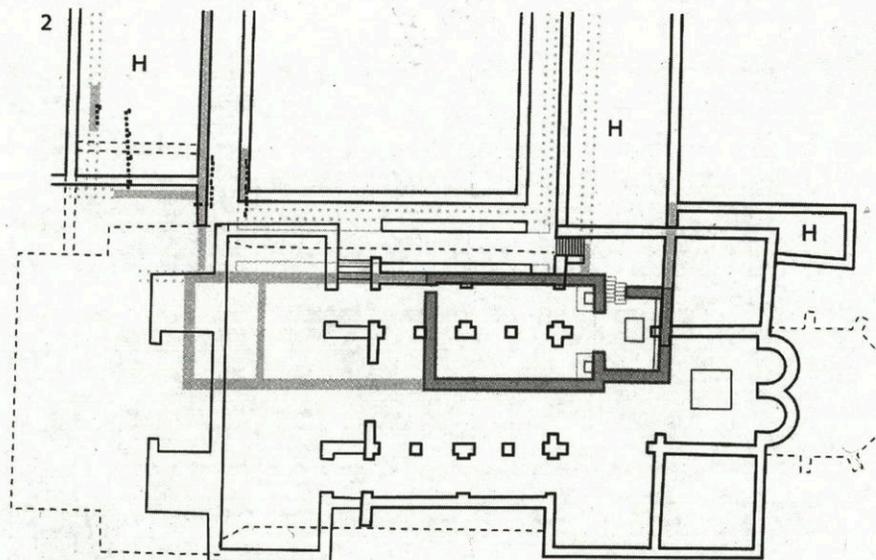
Reichenau-Mittelzell, Klosterkirche, Grundriss mit der ersten Saalkirche.
